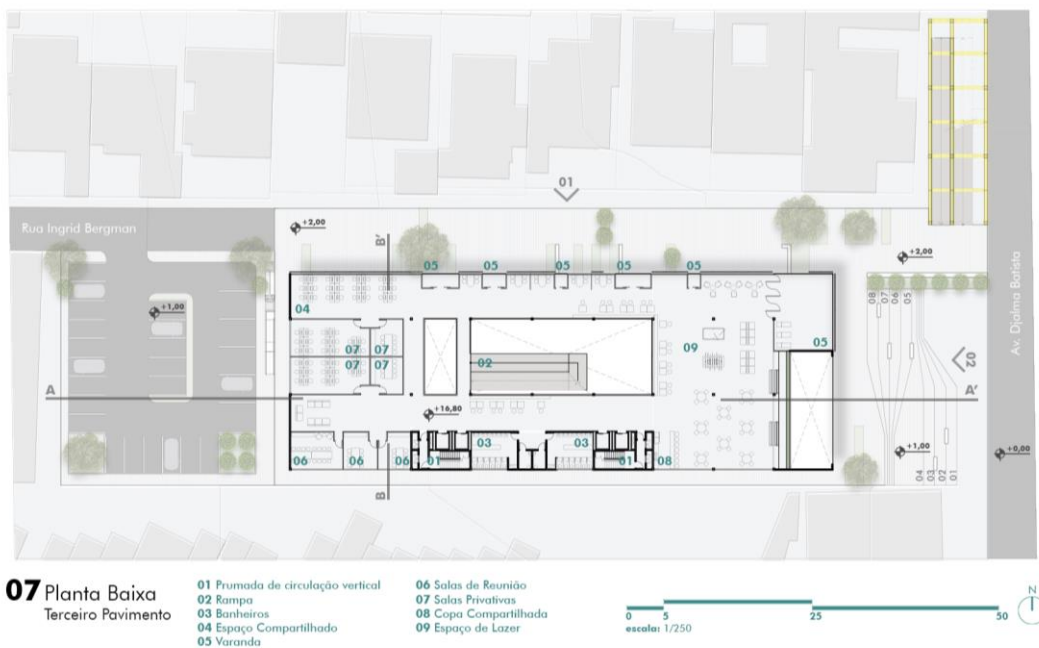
Planta Baixa Terceiro Pavimento. Fonte: acervo da autora, 2021
